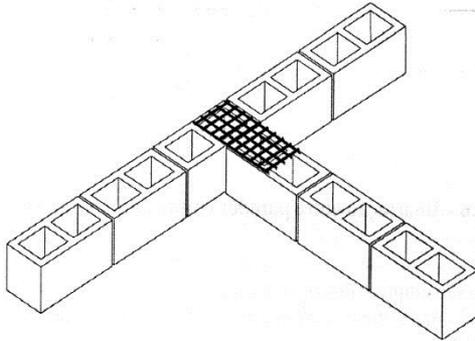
Amarração entre paredes empregando-se tela metálica
